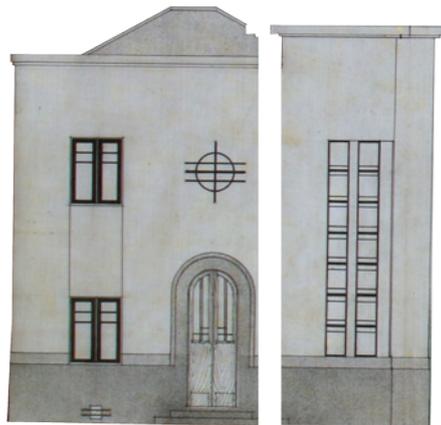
| Esquema que ilustra a divisão entre o volume da fachada e o elemento que contém a janela vertical, elevado na platibanda;
